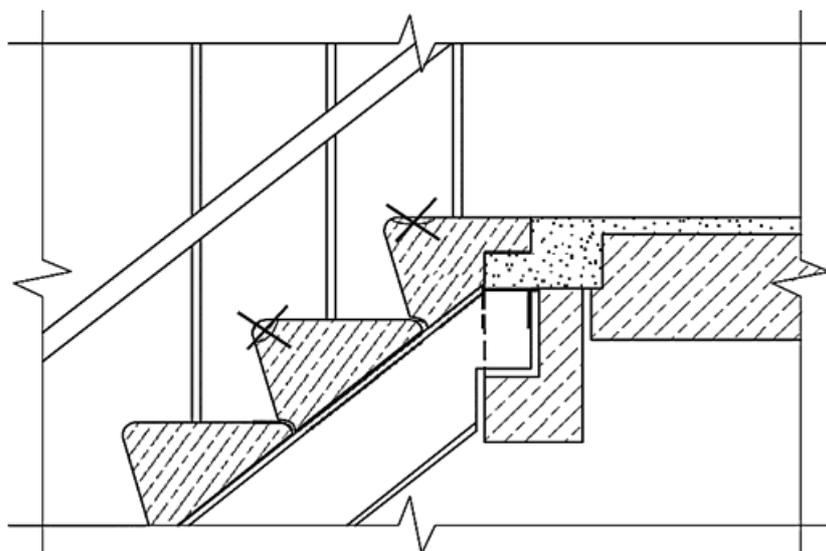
Образование сколов и разрушений железобетонных ступеней лестниц
